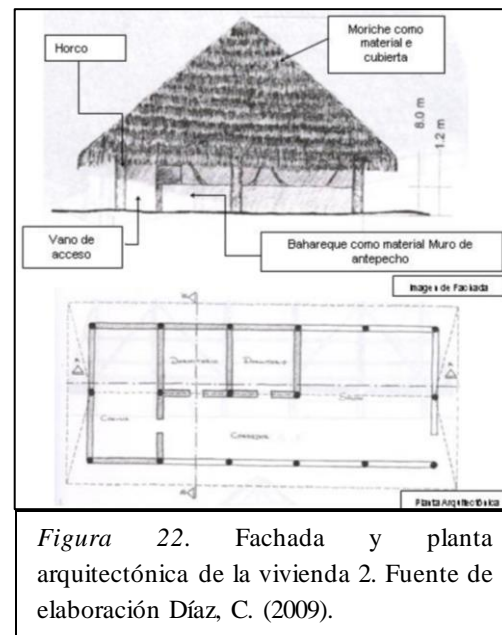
Fachada y planta arquitectónica de la vivienda 2. Fuente de elaboración Díaz, C. (2009).
